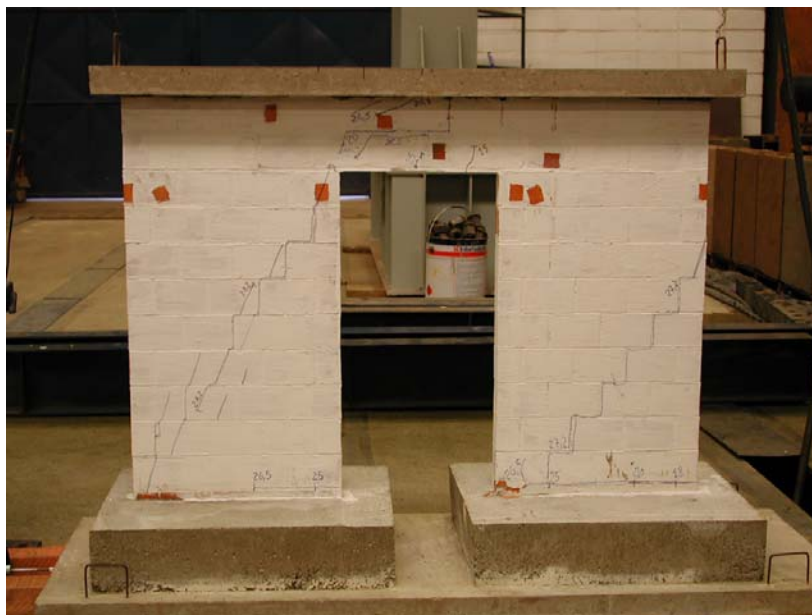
Vista geral do modelo PPSG1 após realização do ensaio.
